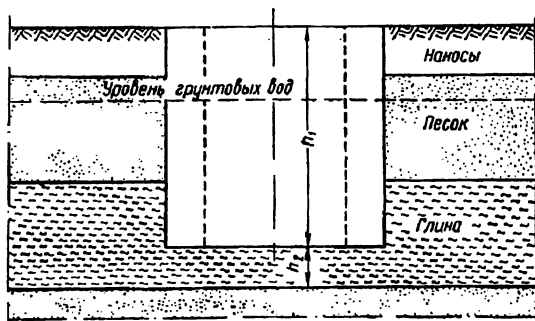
Схема к проверке слоя грунта на прорыв напорными водами
